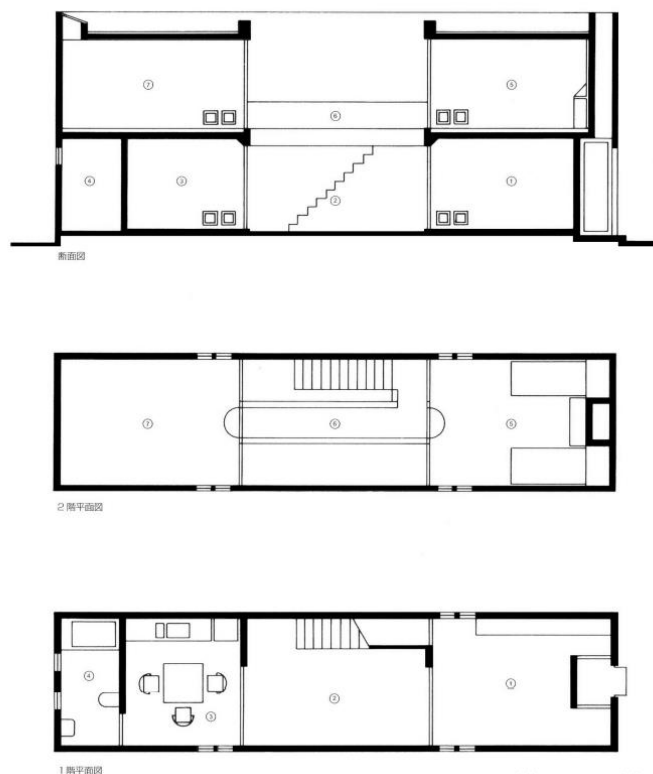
Casa Azuma. De cima para baixo: corte longitudinal; planta do piso 1; planta do térreo. Osaka, Japão, 1976 – Tadao Ando.
